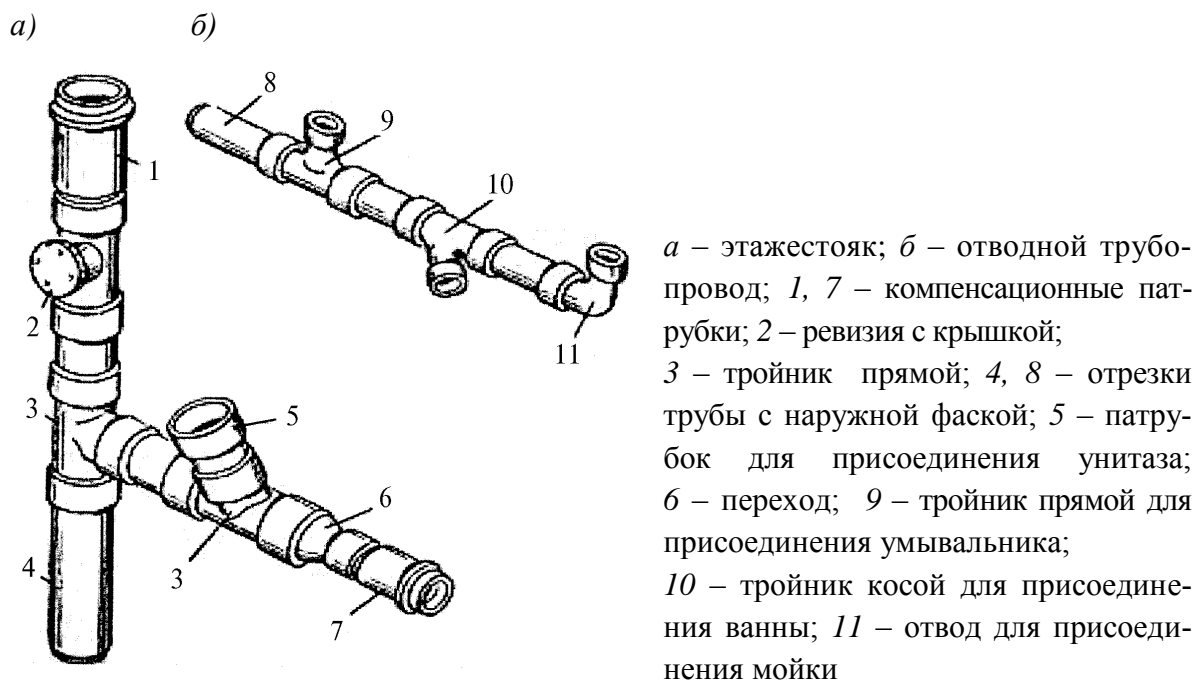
Трубозаготовки для внутренней канализации, выполненные из полиэтиленовых трубных изделий сваркой в раструб
